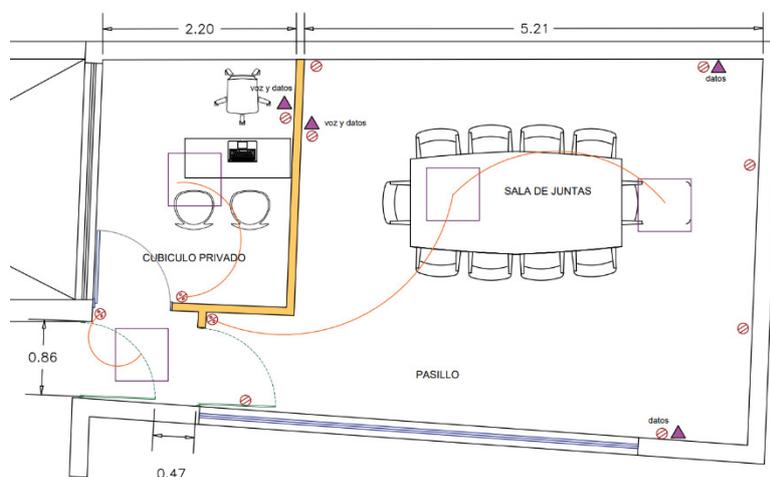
Propuesta de adecuación de comedor anterior para crear un cubículo privado y una sala de juntas. Plano por Dirección General de la Administración.
